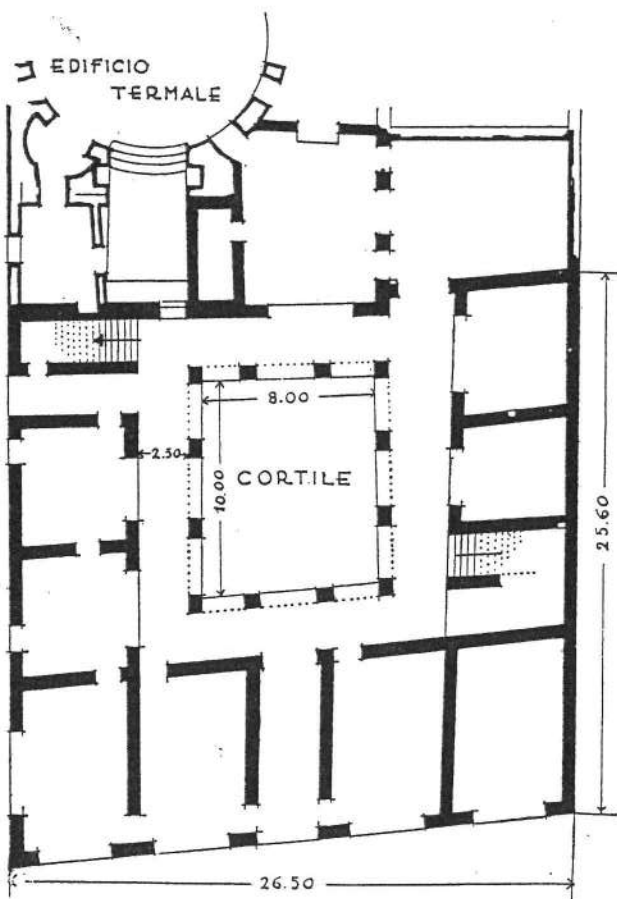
CASA DETTA DEL SERAPIDE: PIANTA
